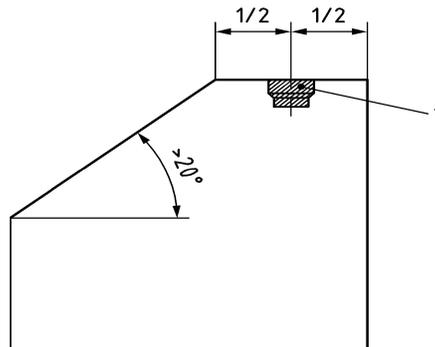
Montaje en habitaciones con techo inclinado y techo horizontal
